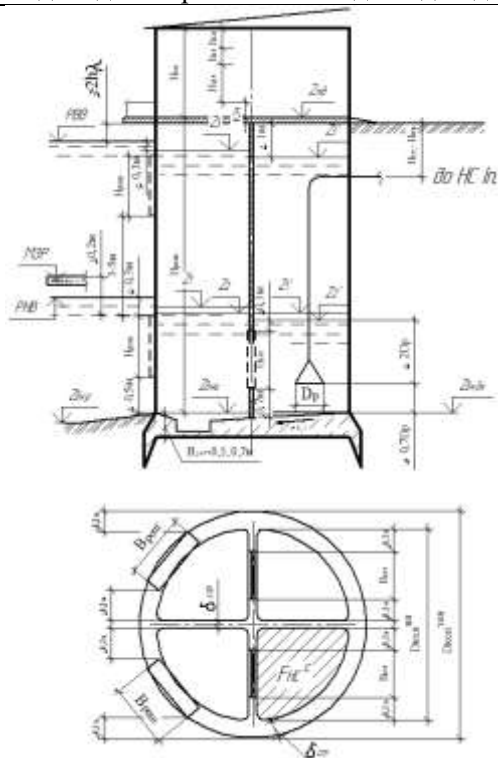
Висотне в планове конструювання водоприймального берегового колодязя (круглої форми в плані)
